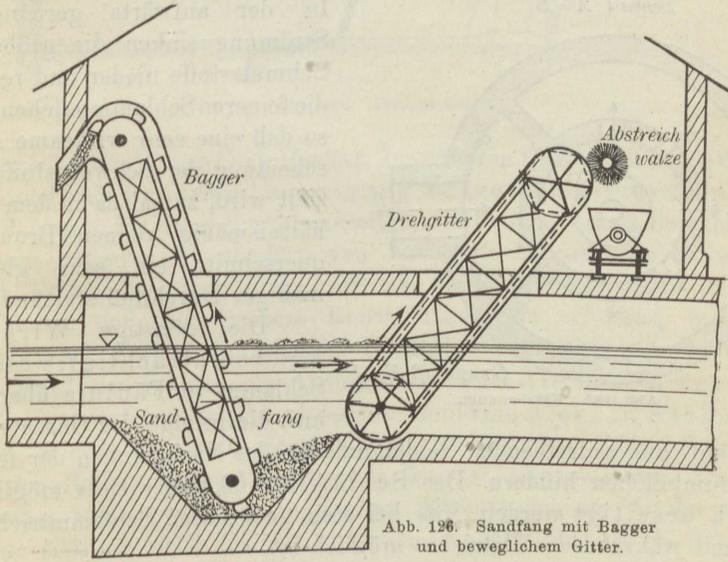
Sandfang mit Bagger und beweglichem Gitter.
